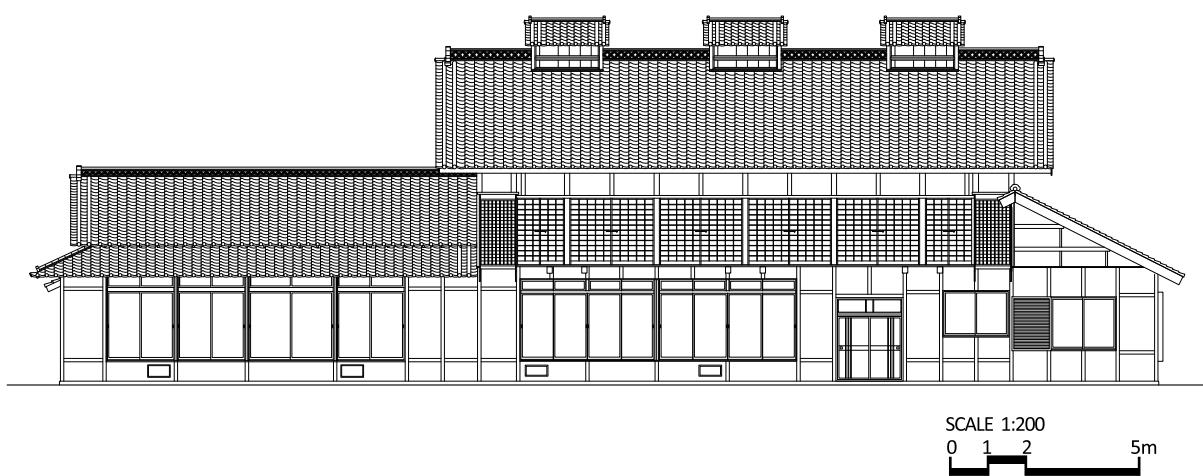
S3 高山社跡 主屋兼蚕室南立面図
